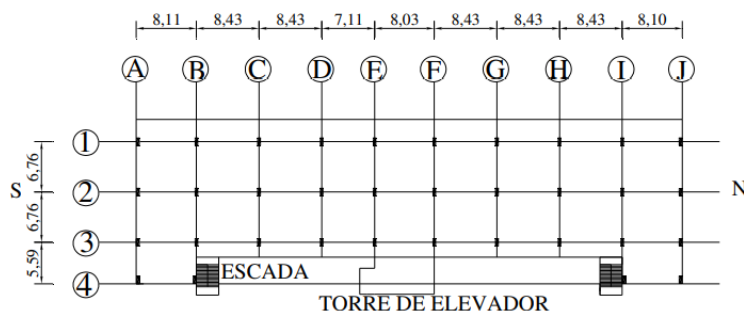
Planta baixa do pavimento tipo e cobertura (LEW *et al*, 1982)
